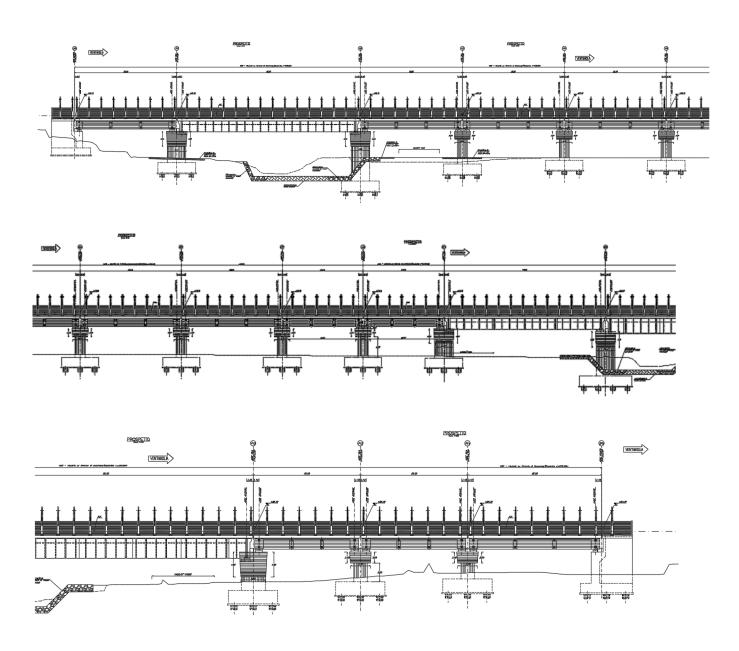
sviluppo longitudinale del viadotto- binario pari
